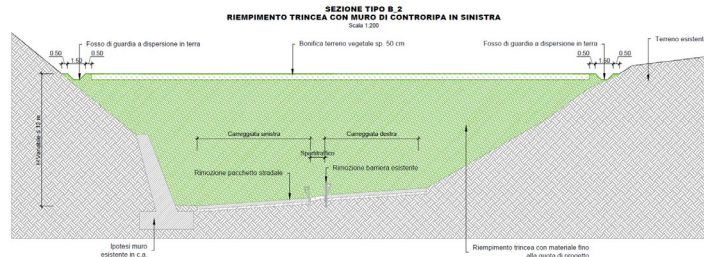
Sezione tipo B_2 riempimento trincea con muro in sinistra
